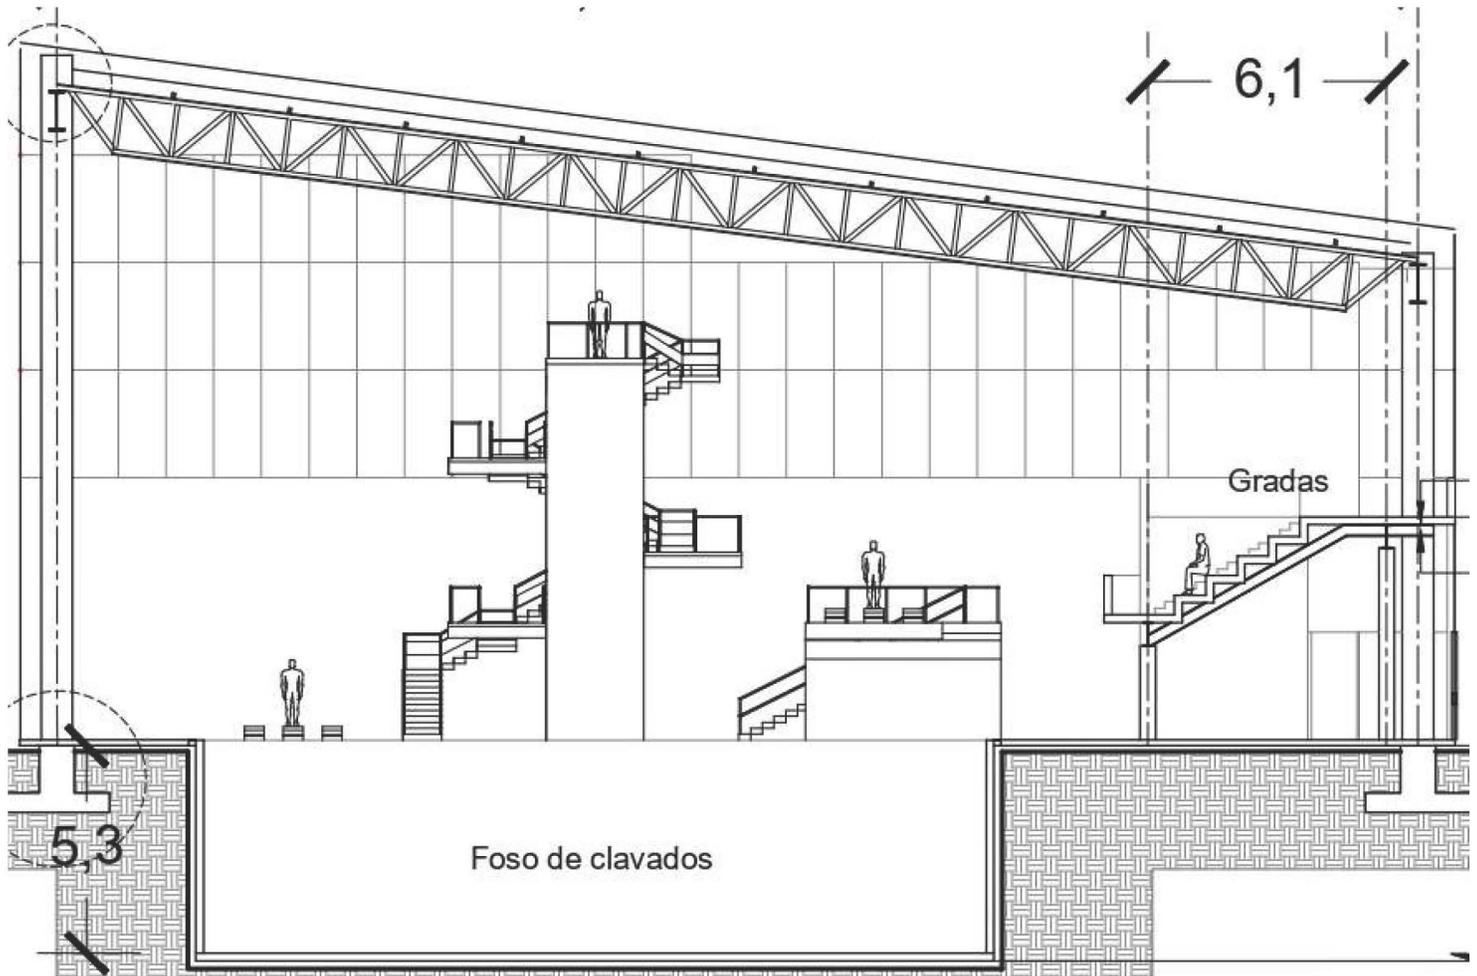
Vista en corte longitudinal del Pabellón Acuático. Profundidad de albercas y estructura de cubierta.
